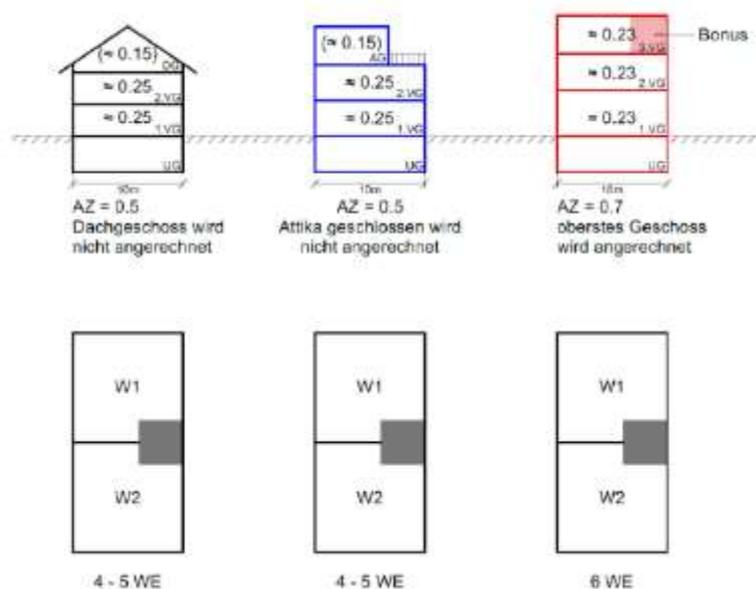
Veranschaulichung Innenentwicklungsbonus in der W2 gemäss § 41 BNO (rote Darstellung) durch Ausbau des Attikas zum Vollgeschoss ermöglicht mehr Wohneinheiten und damit mehr Einwohner auf derselben Gebäudegrundfläche (Quelle: PLANAR 2023)
